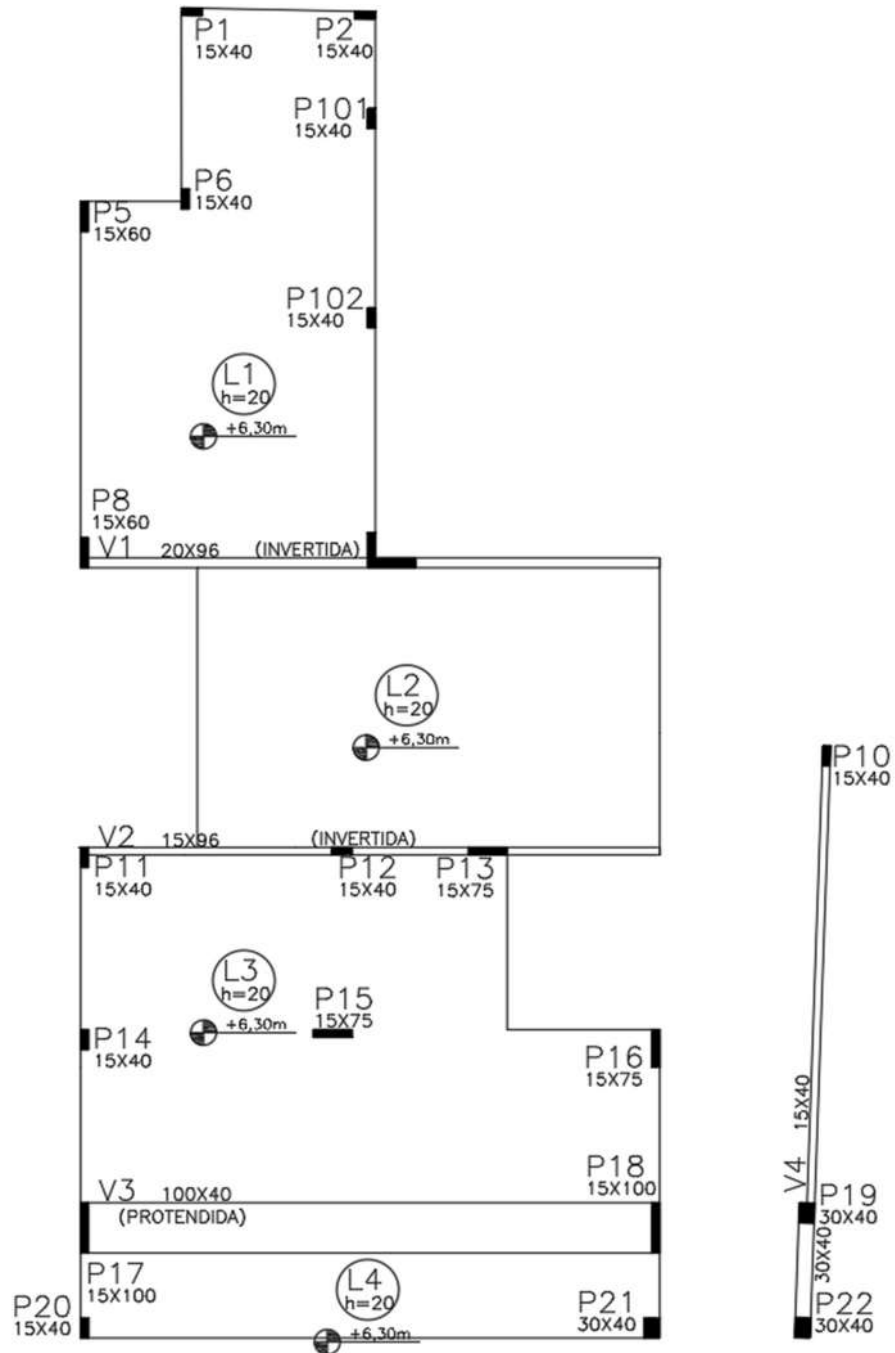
Planta de forma do Pavimento Superior (medidas em cm).
